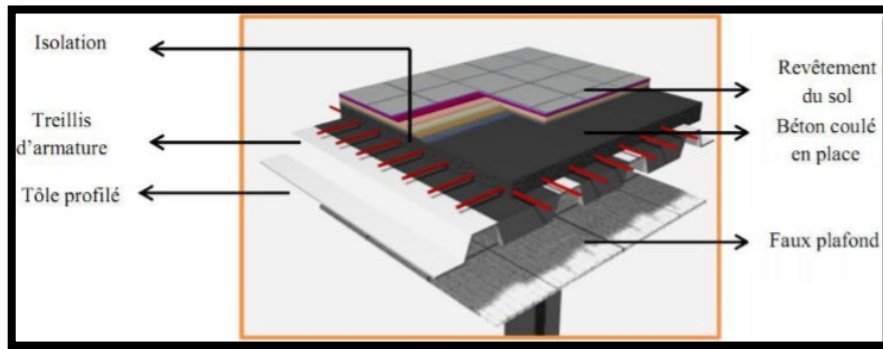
plancher collaborant, [http:// www.bacacier.com](http://www.bacacier.com)
